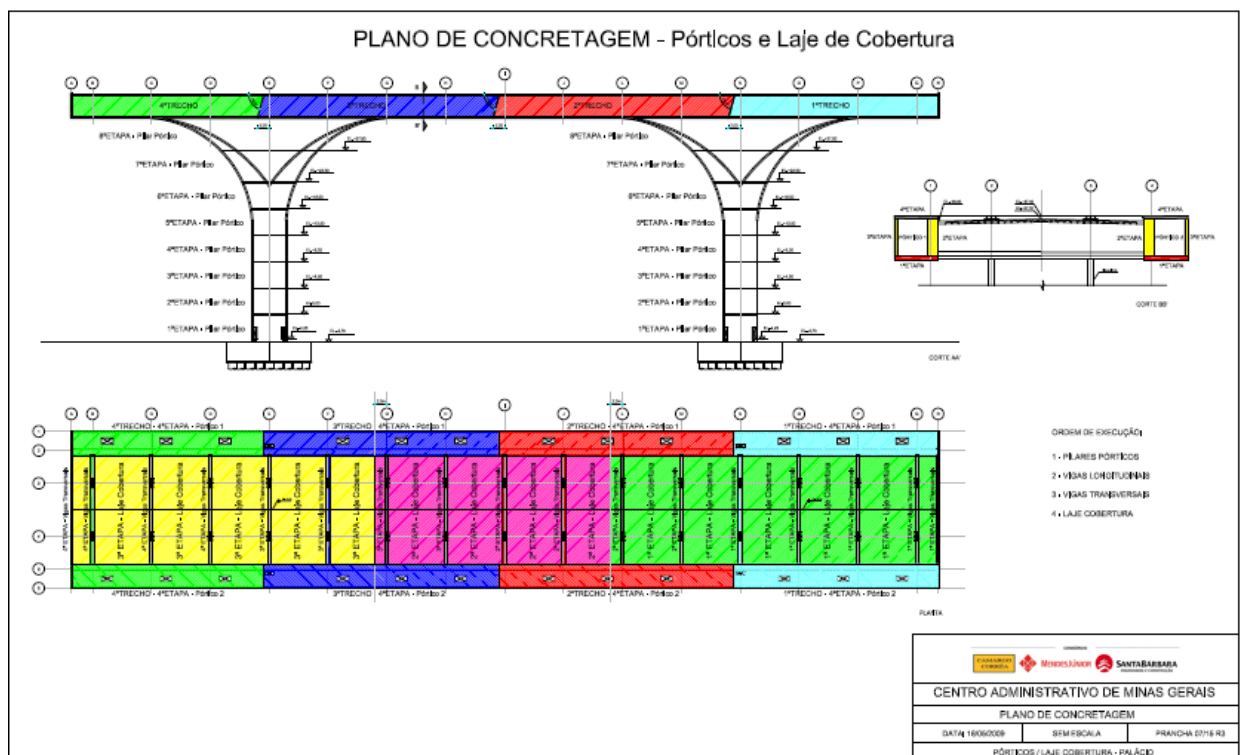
Plano de concretagem dos pórticos e cobertura
